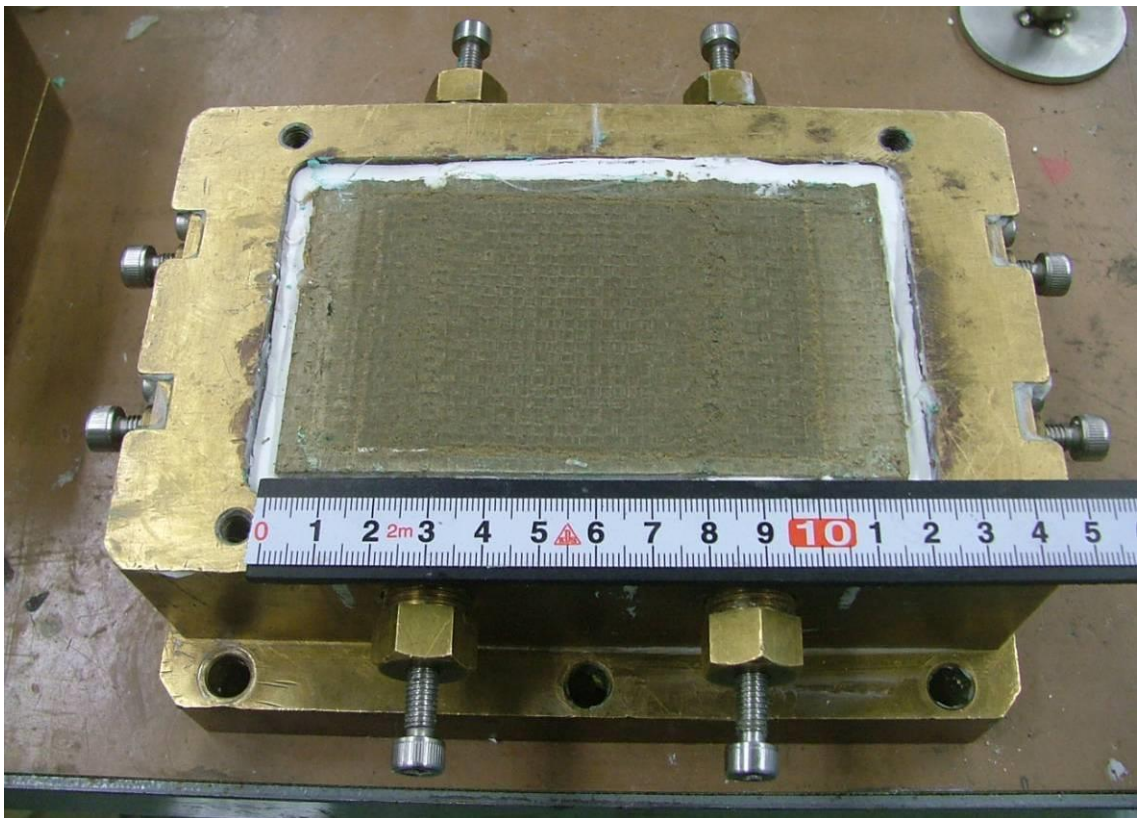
繰返し荷重試験 試験後の供試体状況 ケース 1-8 (西山モルタル表面)
